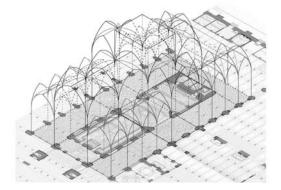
Referencia tipológica genérica para una catedral tardogótica de tres naves y crucero a comienzos del siglo XVI, adaptada a las condiciones de la mezquita. Realizado sobre planimetría
